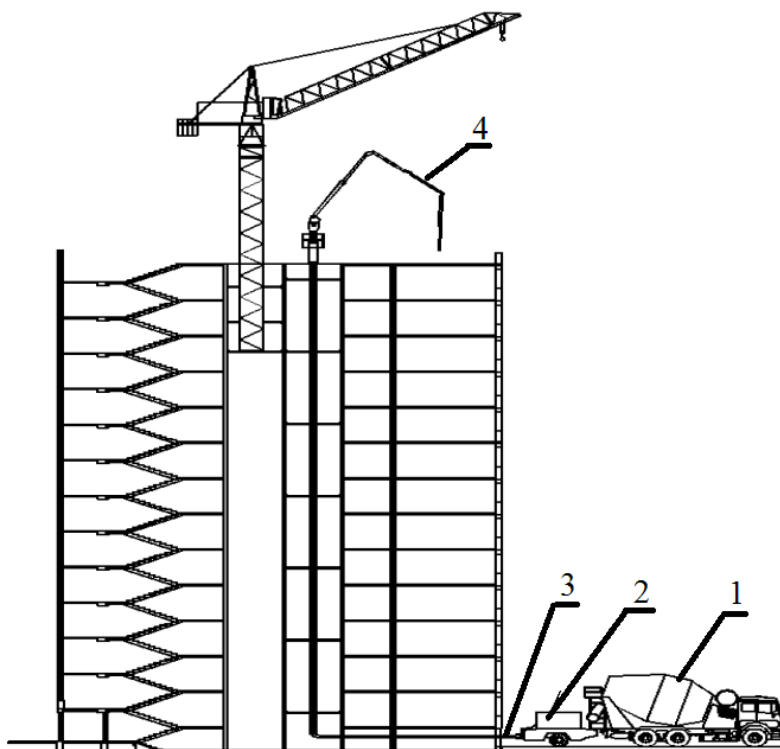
Схема подачи бетонной смеси бетононасосом: 1 – автобетоносмеситель; 2 – бетононасос; 3 – бетоновод; 4 – автономная распределительная стрела
